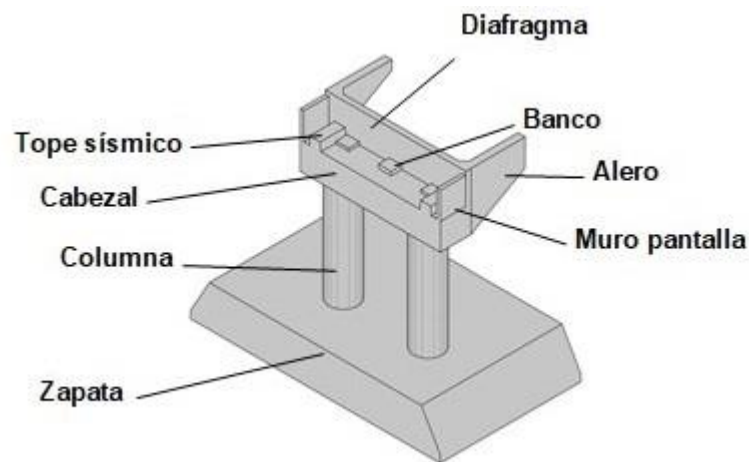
Elementos de un caballete con cimentación superficial (Manual para Inspección de Puentes, 2018).
